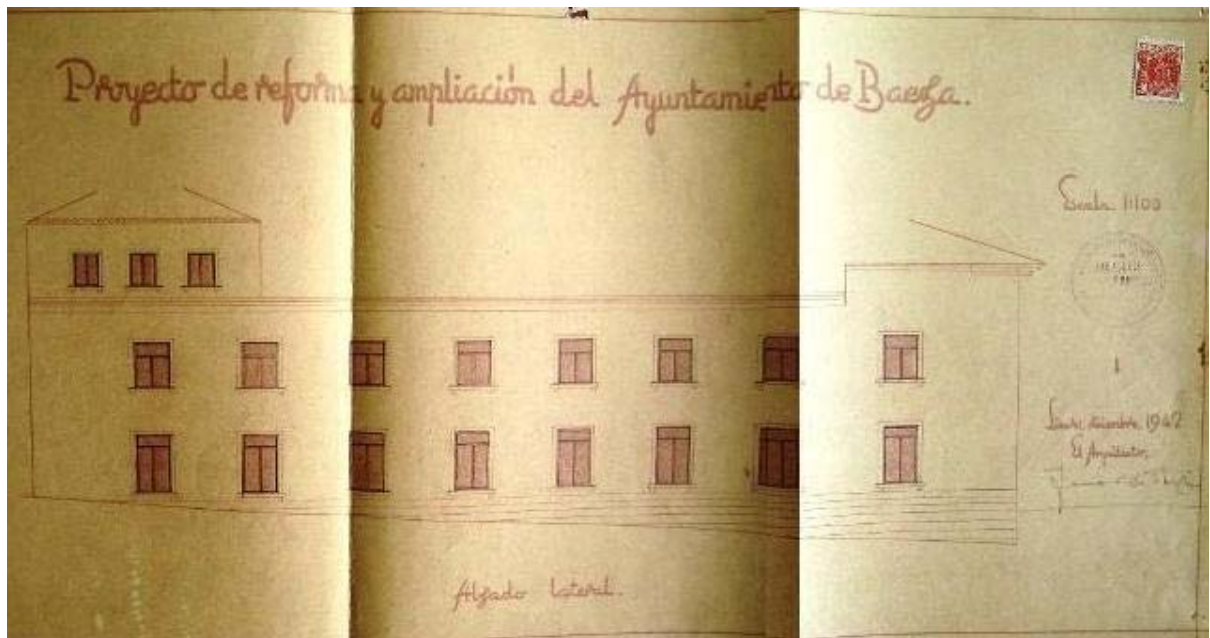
Proyecto de alzado lateral. Nueva fachada.
